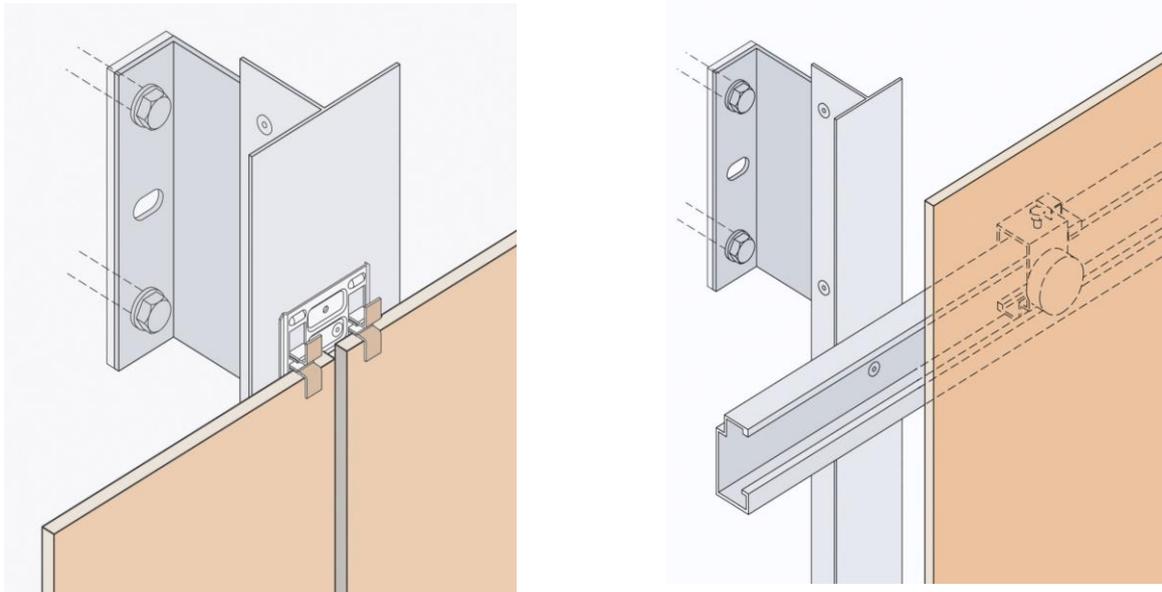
Sichtbare (links) und verdeckte (rechts) Befestigung der Keramikplatten [12]
